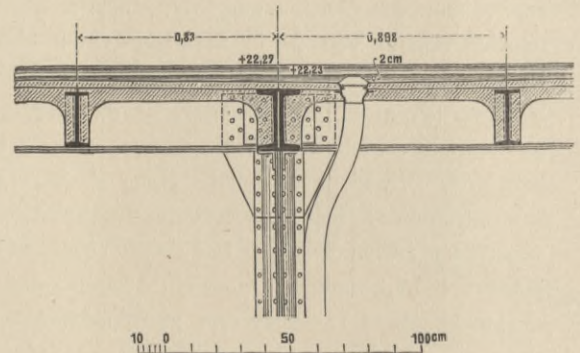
Längenschnitt durch die Decke der Maschinenkammern in der Mittelmauer der Schleuse in Holtenau.
